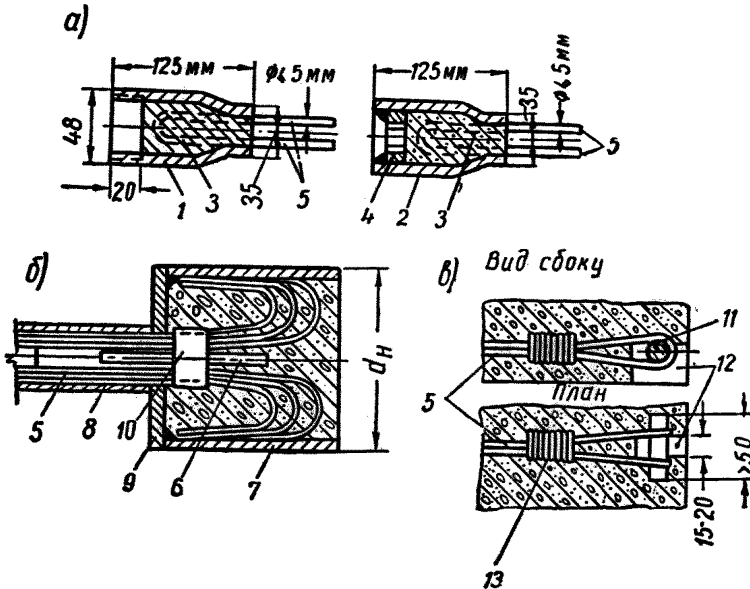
Анкеровка арматурных пучков проволоки из твердых сталей в предварительно напряженных железобетонных конструкциях
